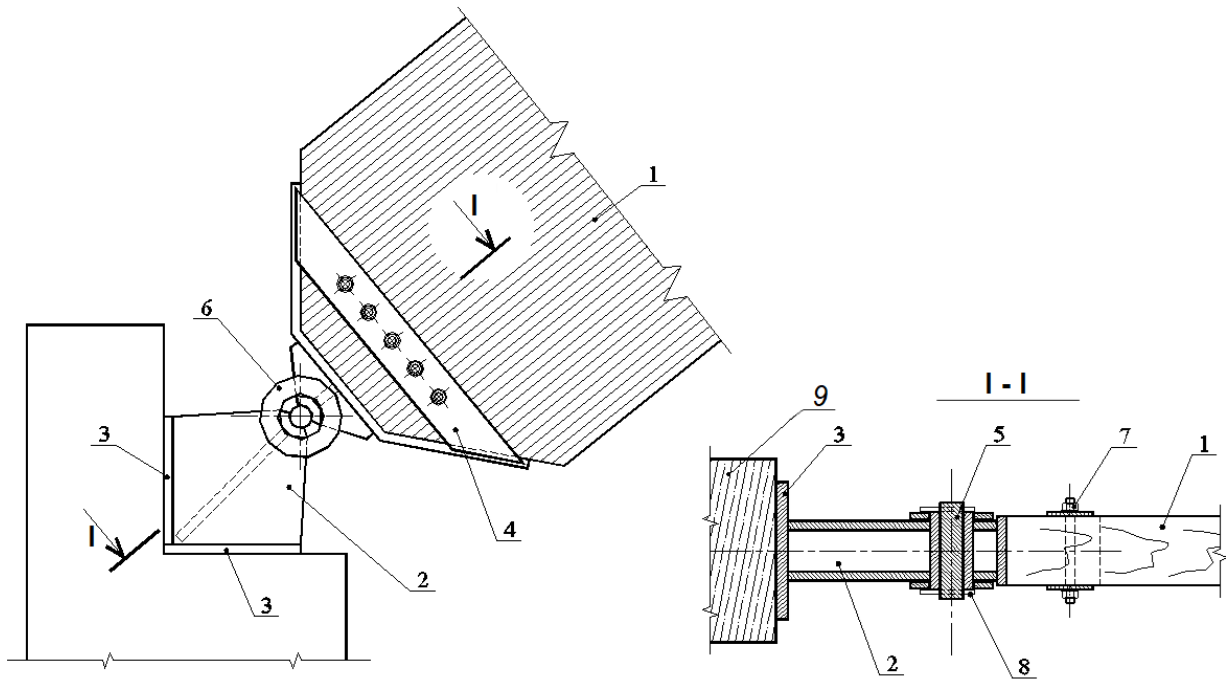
Схема шарнирного узла опирания арки на железобетонную опору
